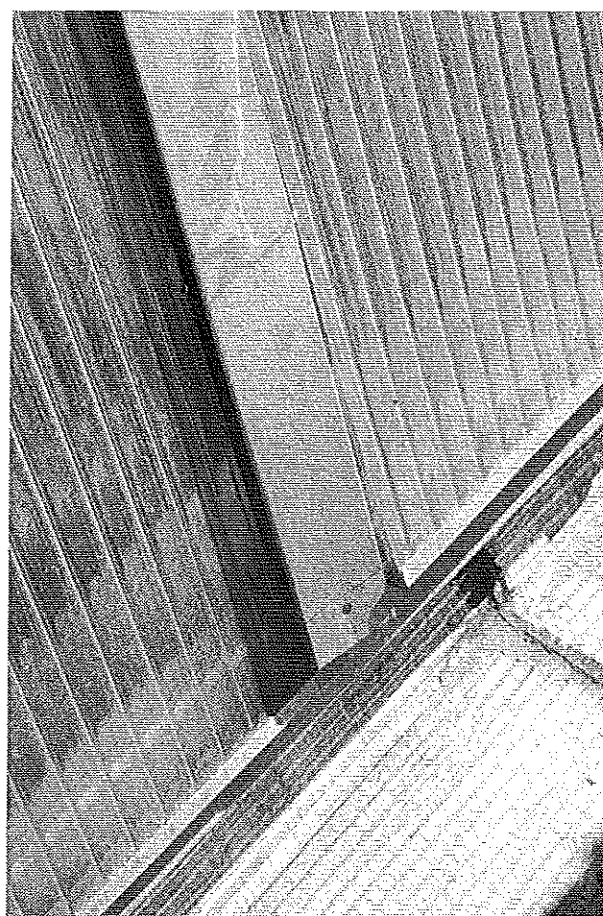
Détail bas de la lisse verticale de fixation. © J. Putatti
